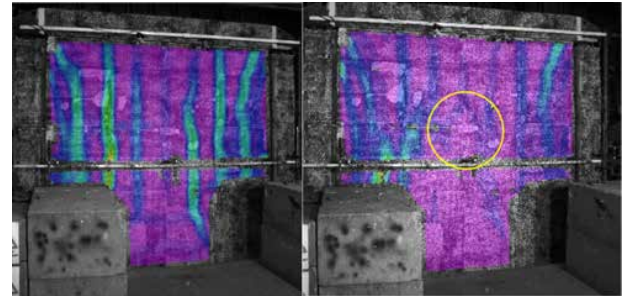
À gauche : Fissures verticales après 10 min d'exposition au feu d'un mur en pierre
